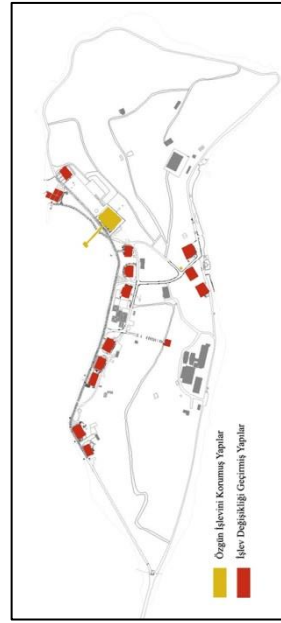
Klazomen Tahaffuzhanesi Planı (Adak, 2021).
